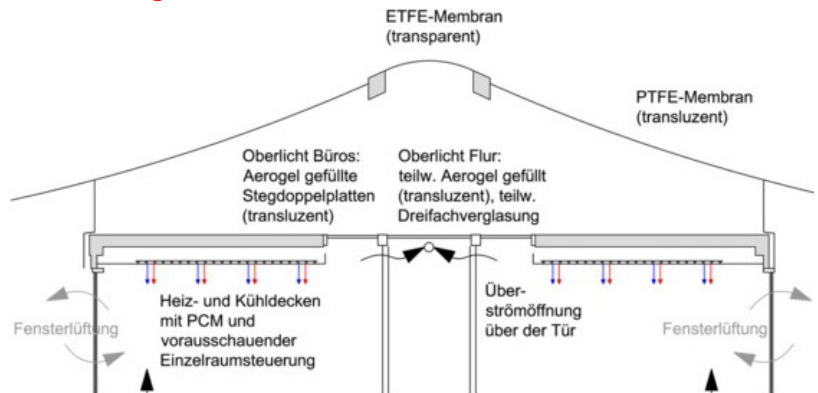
Schematischer Querschnitt durch den Dachaufbau des Hauptdaches
